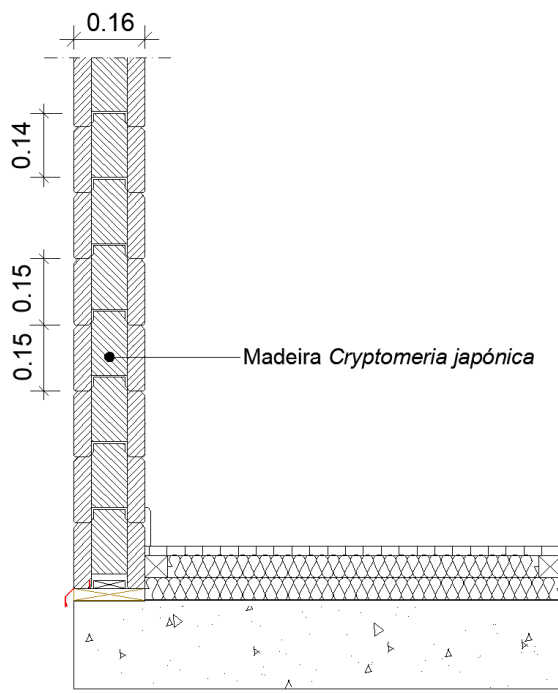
Características geométricas do sistema de fachada “Laminated Timber System – LTS 160”. Vista em corte (dimensões em metros).
